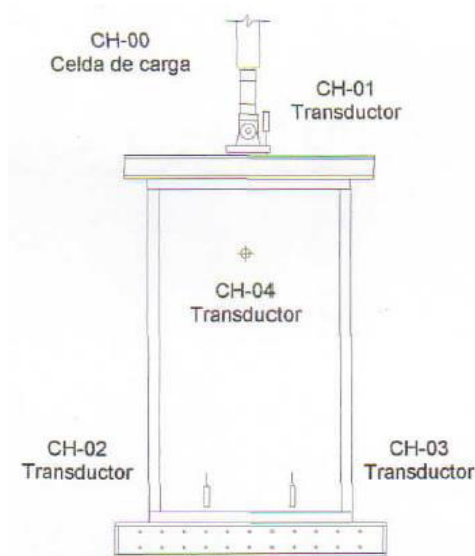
Esquema del Ensayo de Compresión Axial para Panel Sándwich
